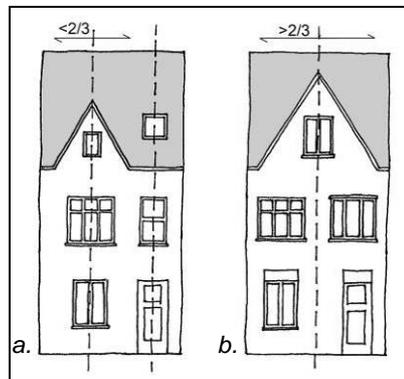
Possibilité d'implantation de fenêtres de toit pour les façades à pignon
